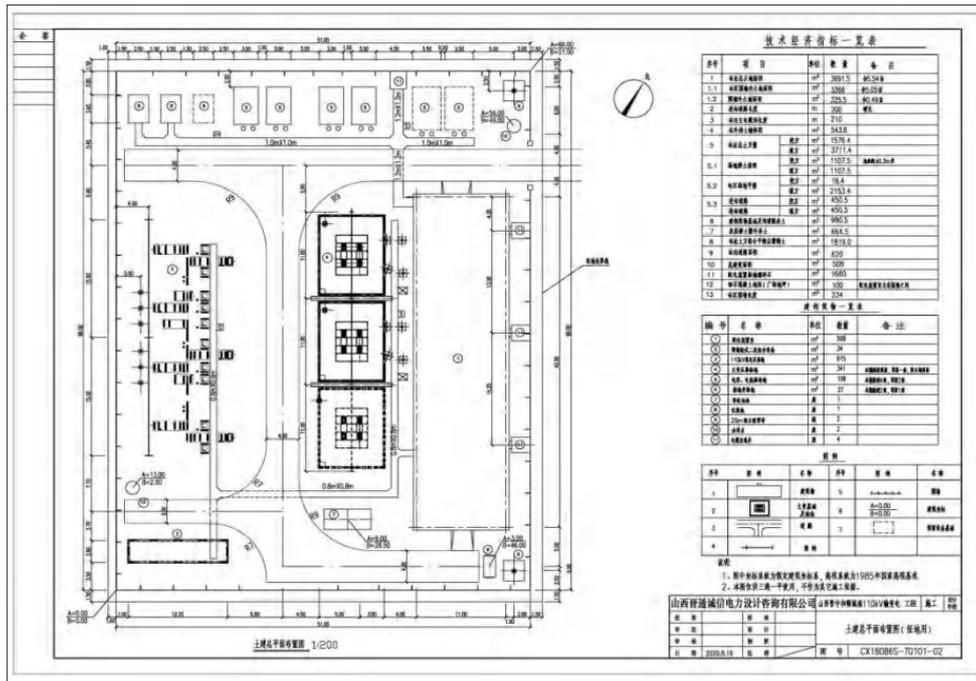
晋中和顺锦和 110kV 变电站平面布置示意图
